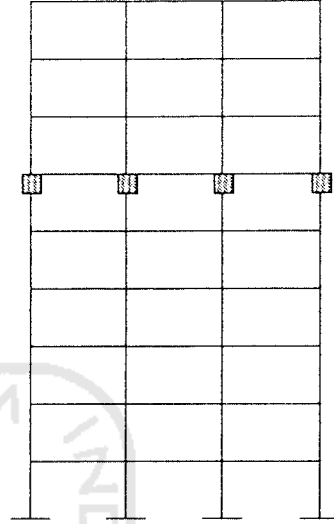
Tingkat 9 lantai ke 3
